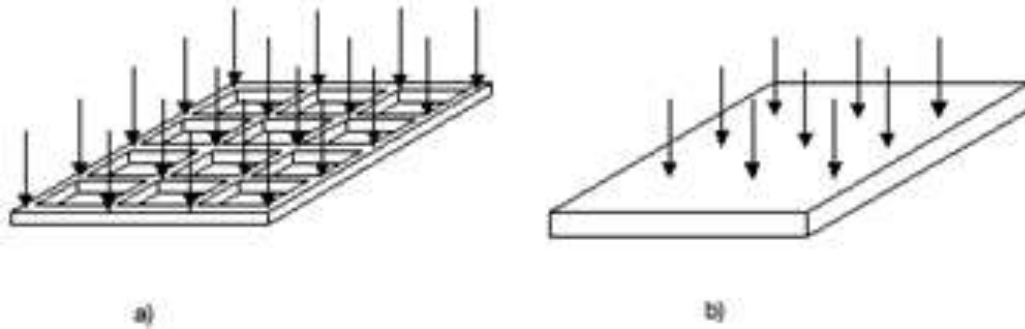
Losas de cimentación superficial típicas: (a) Cimentación nervada; (b) Losa de cimentación
